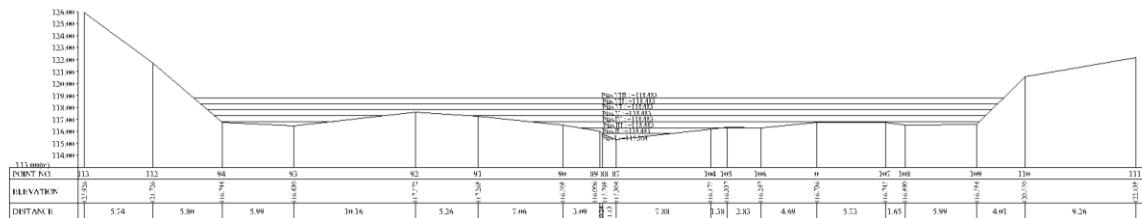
Hubungan debit dan tinggi muka air hulu bendung
